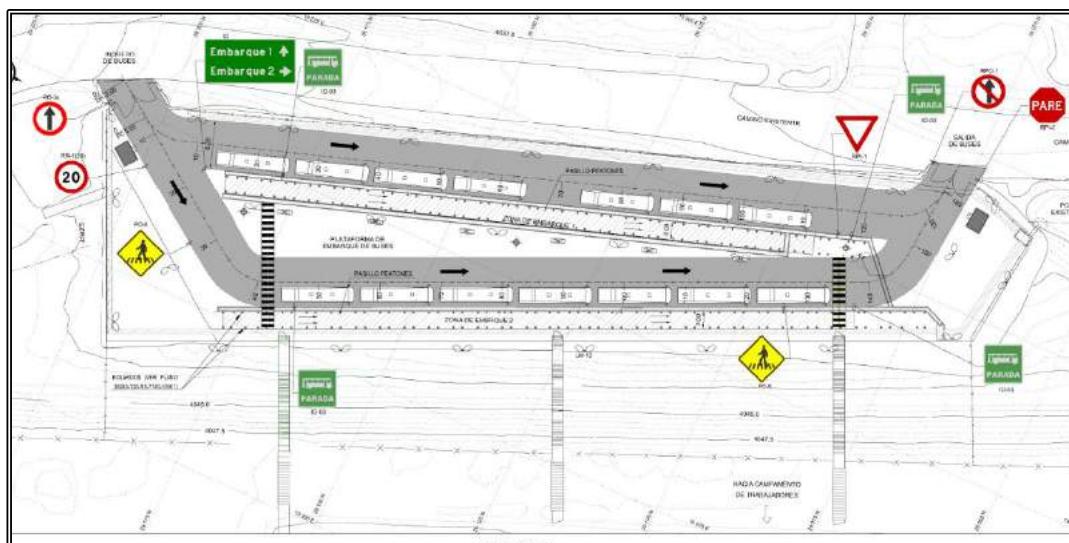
Vista en Planta – Plataforma de Embarque y Desembarque de Personal
